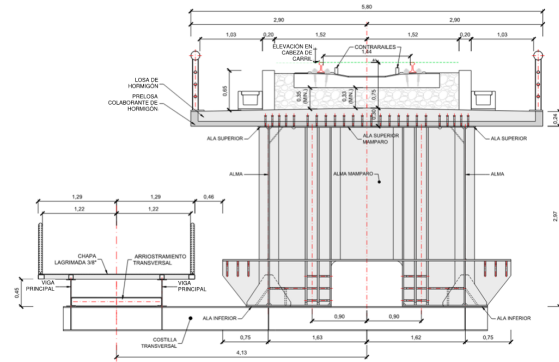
Sección transversal del tablero del viaducto y la pasarela, en la zona de apoyo.
